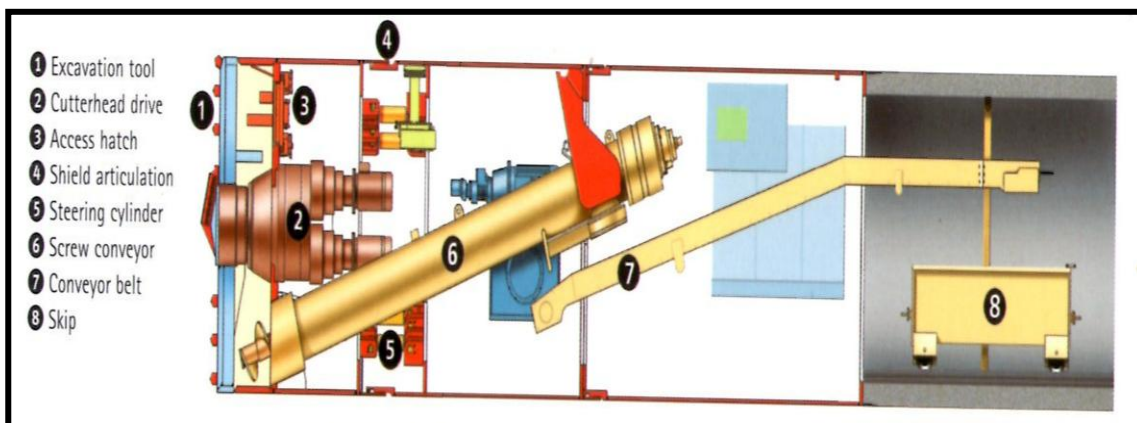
Estructura interna de una máquina EPB. Herrenknecht 2011
